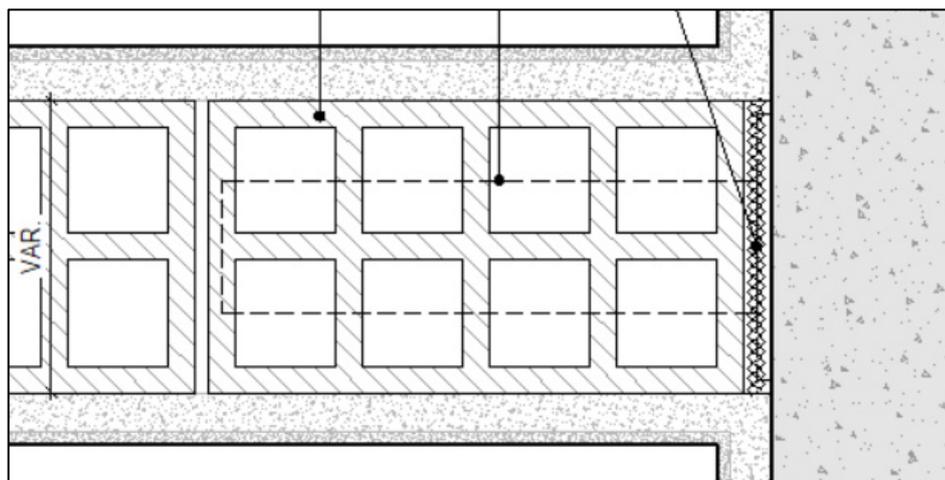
Representação de ligação do pano de alvenaria à estrutura.
